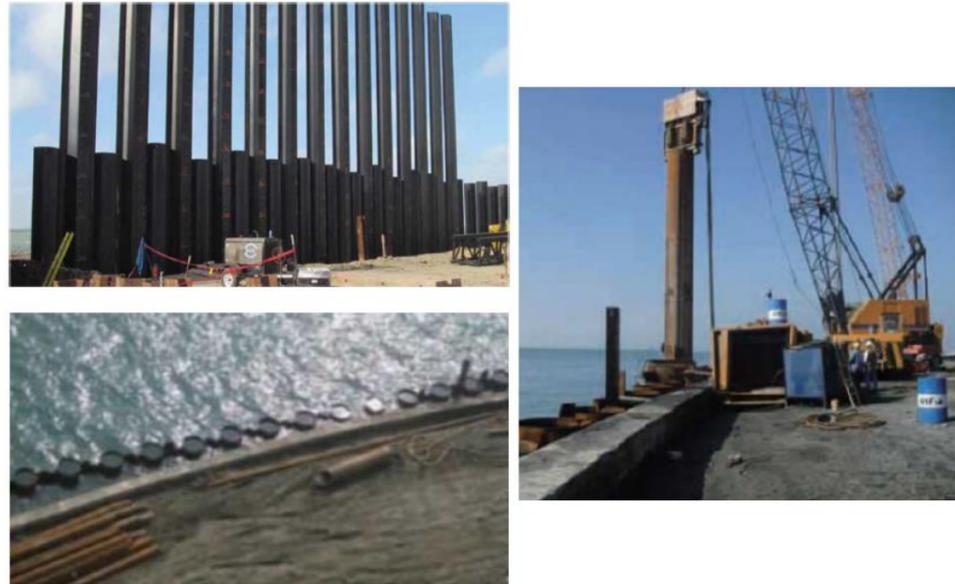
Exemple de chantier de type combiwall (pieux + palplanches)
